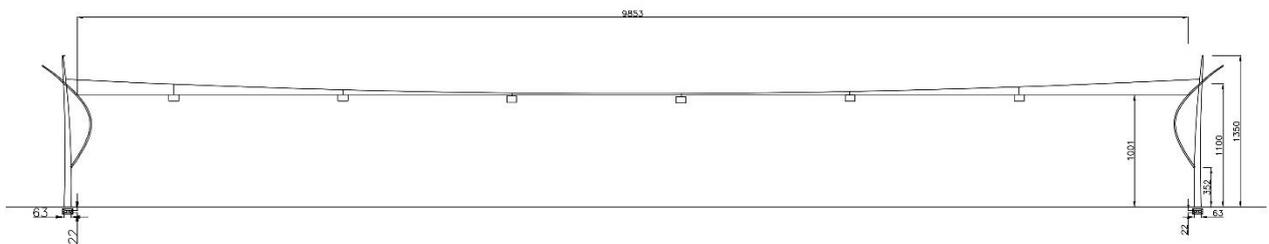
Progetto di illuminazione Piazza Bengasi – prospetto
